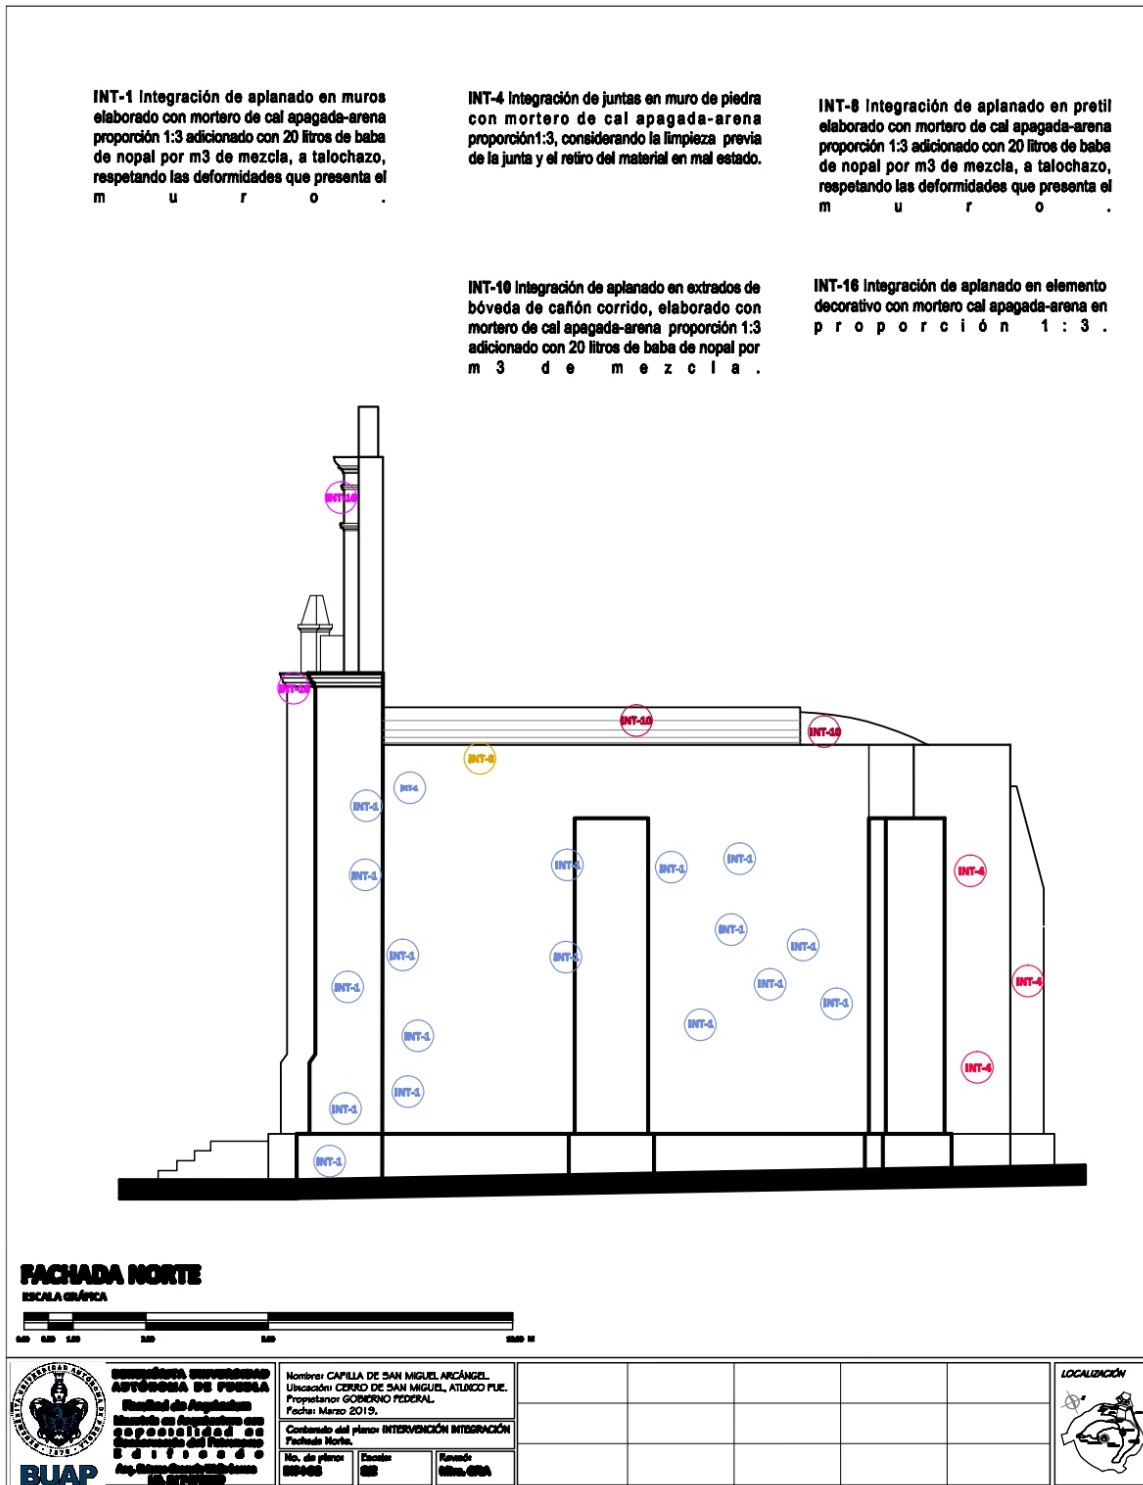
Plano 7 de integraciones en fachada norte. Elaboración: Graciela Walls marzo de 2019.
